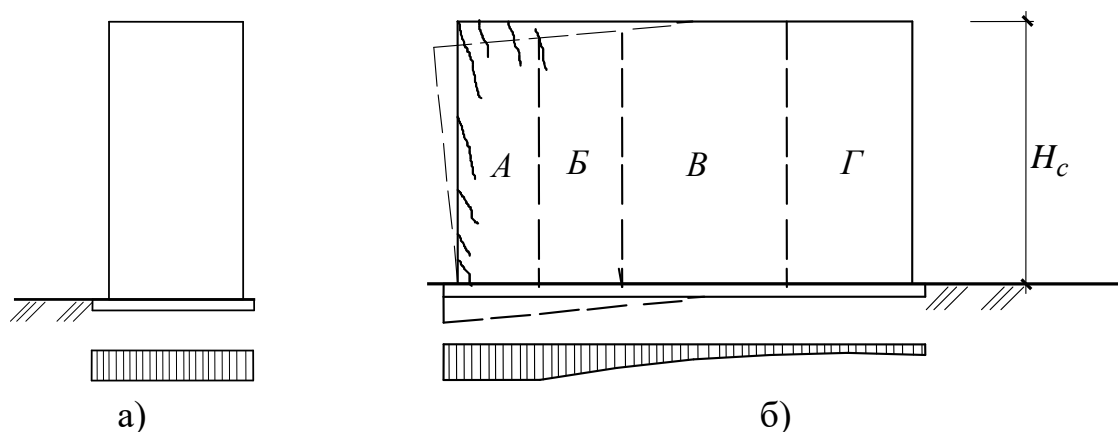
Схема силового впливу будівлі: а – будівля, що існує; б – будівля, що будується
